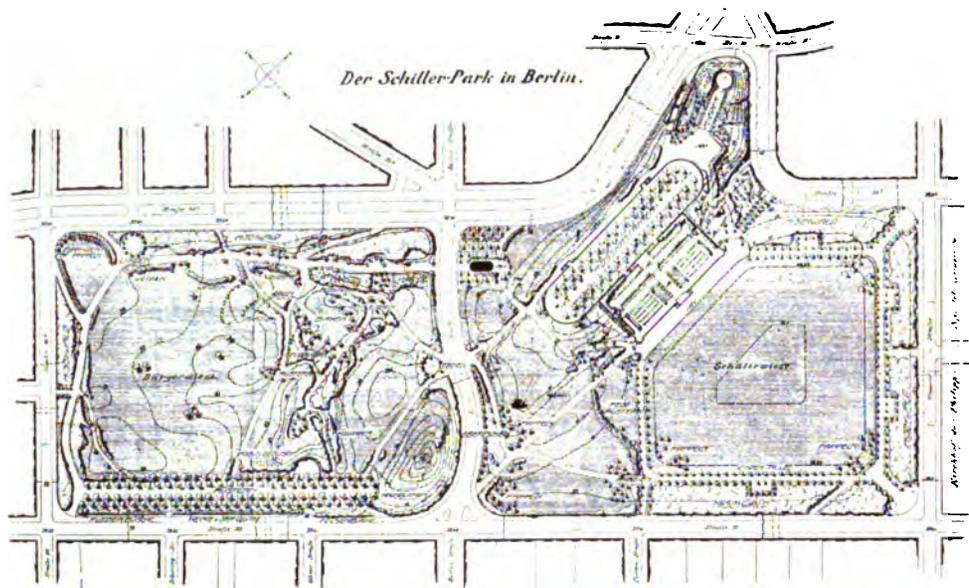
Schillerpark in Berlin. Lageplan der ausgeführten Anlage von Friedrich Bauer, Magdeburg.
